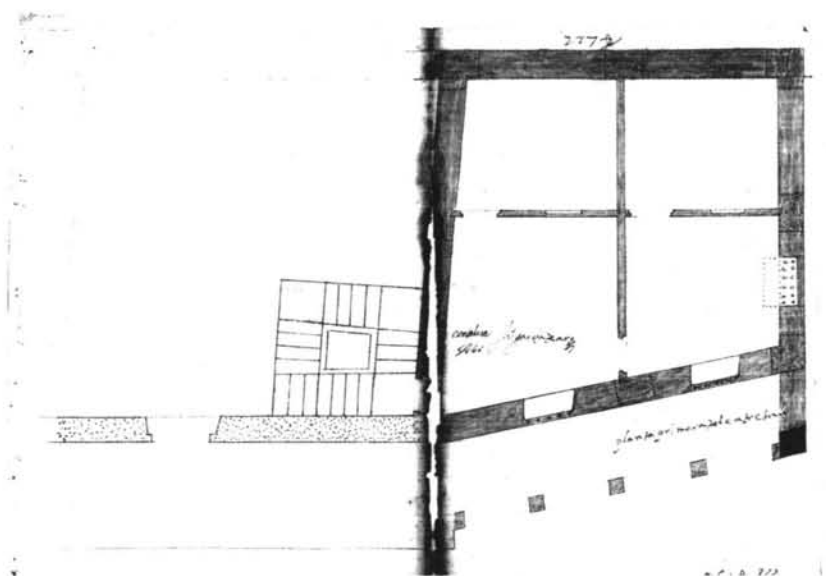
Juan García de Aro. 1655. A la izquierda, planta baja del Ayuntamiento de Toro. A la derecha, planta de entresuelos de las casas accesorias.
